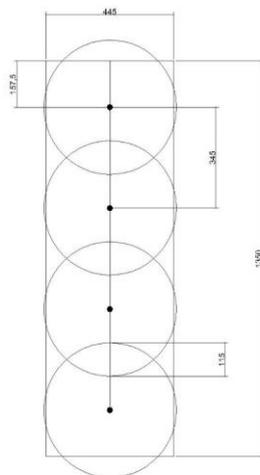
Peletakkan *Sprinkler* di ruang musholla
